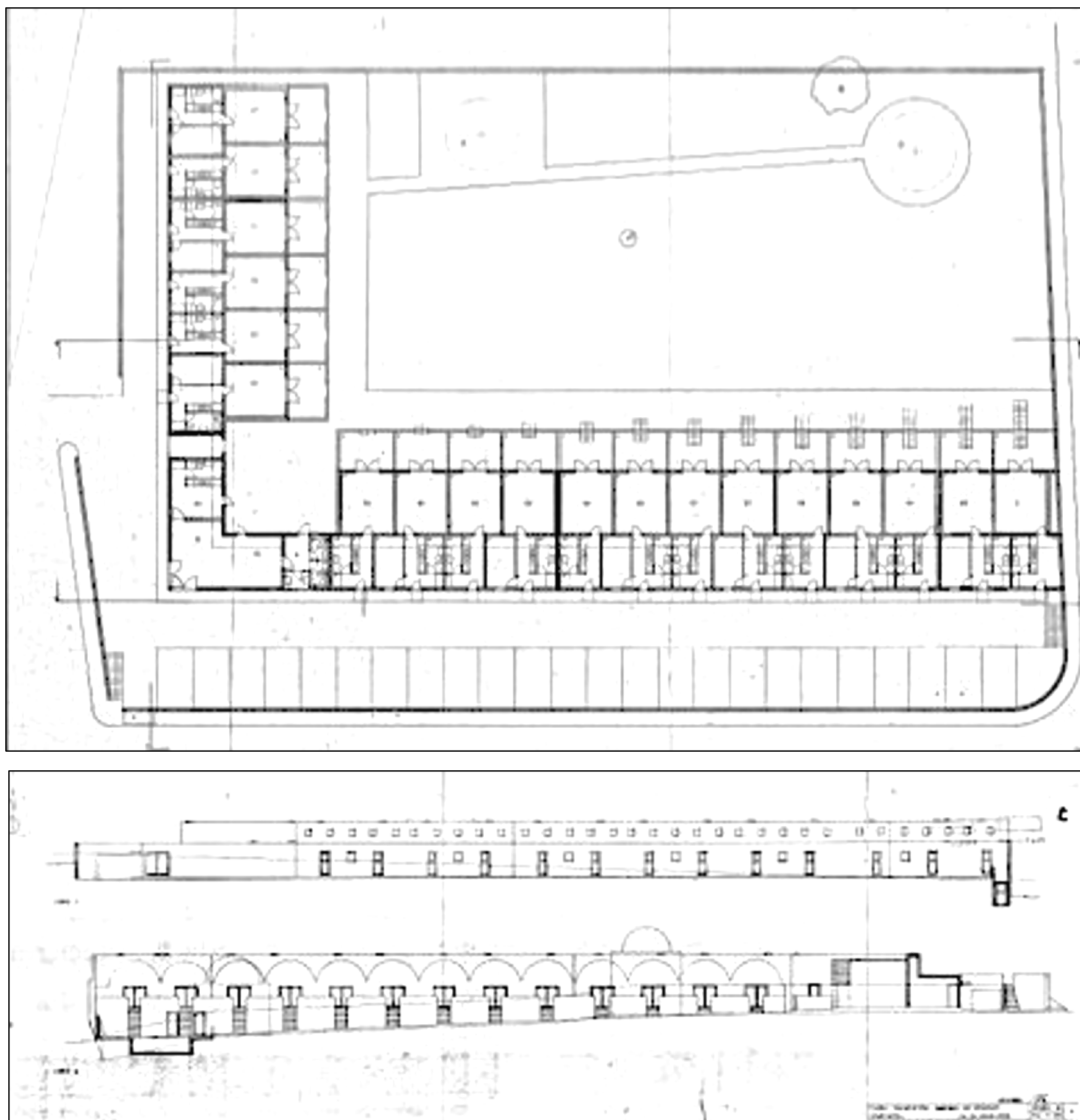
; Planta e alçado do Aparthotel. ²⁹
